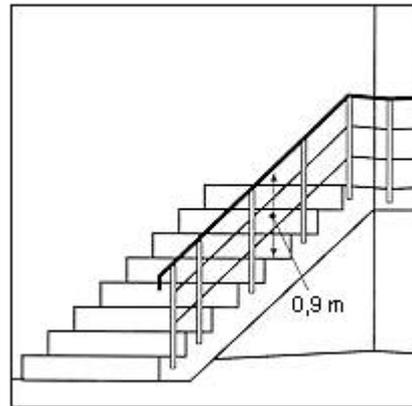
Escalera protegida con barandillas complementadas por dos barras intermedias
